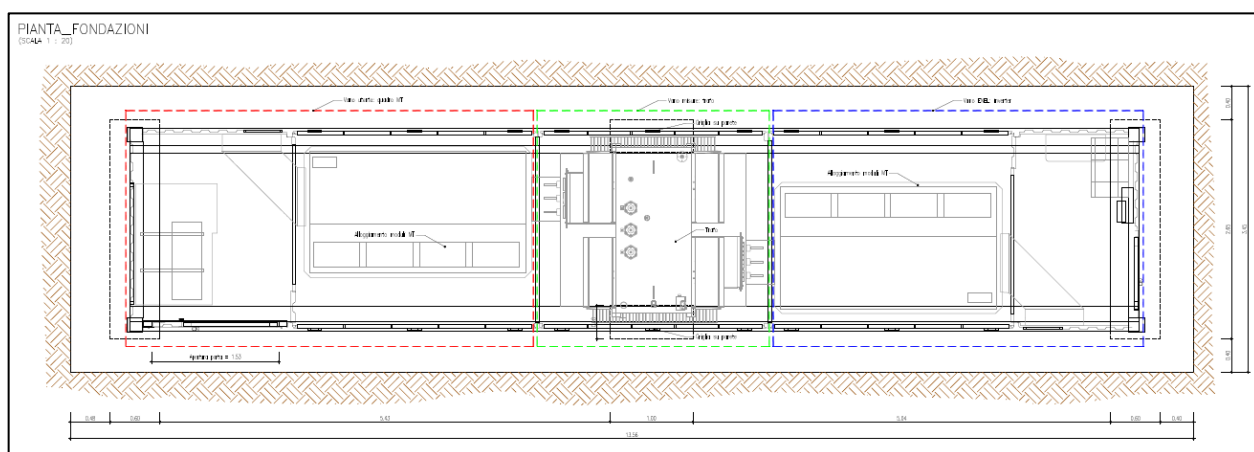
Pianta fondazioni di una cabina di campo e trasformazione
